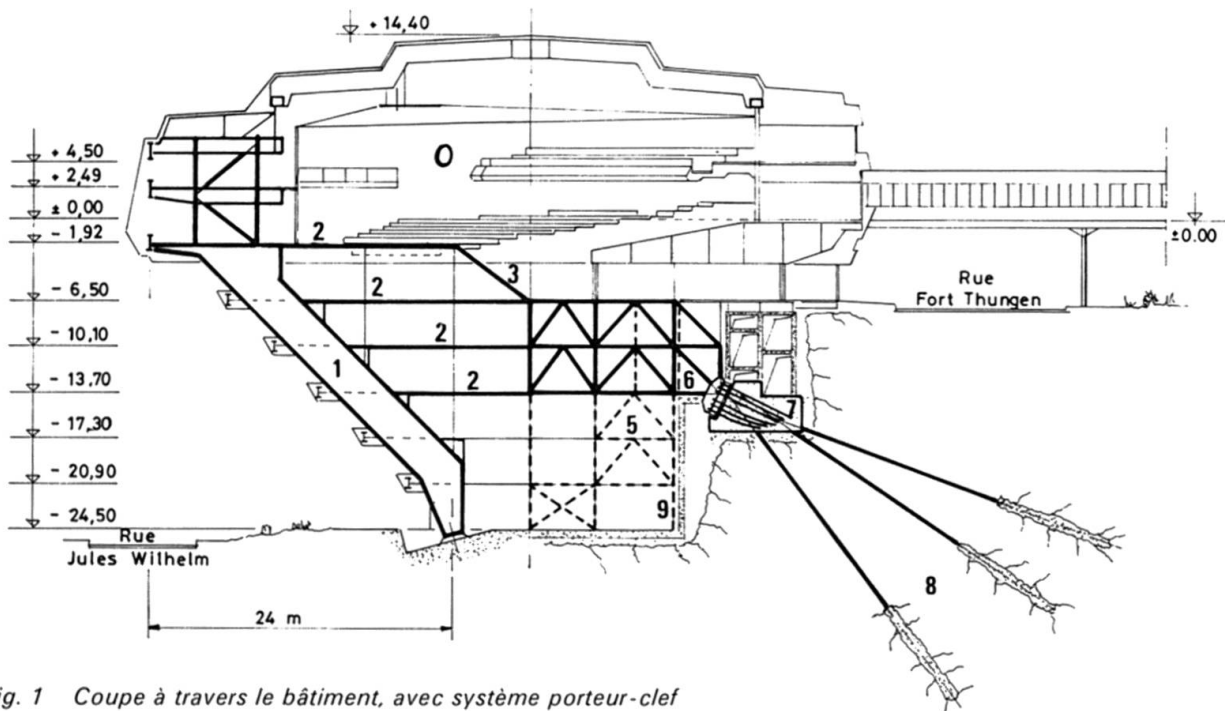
Coupe à travers le bâtiment, avec système porteur-clef
